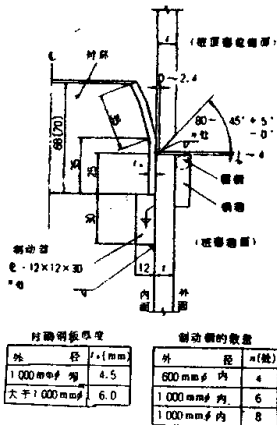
钢管桩的现场半自动焊接接头通用形状及尺寸
